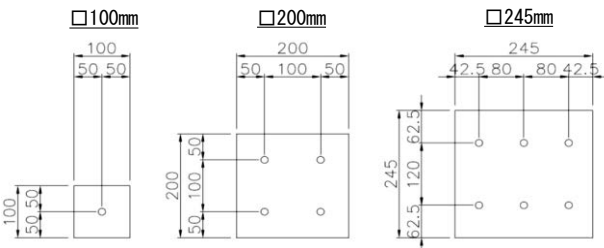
角柱試験体（鉄筋は一部試験体のみ配置）
